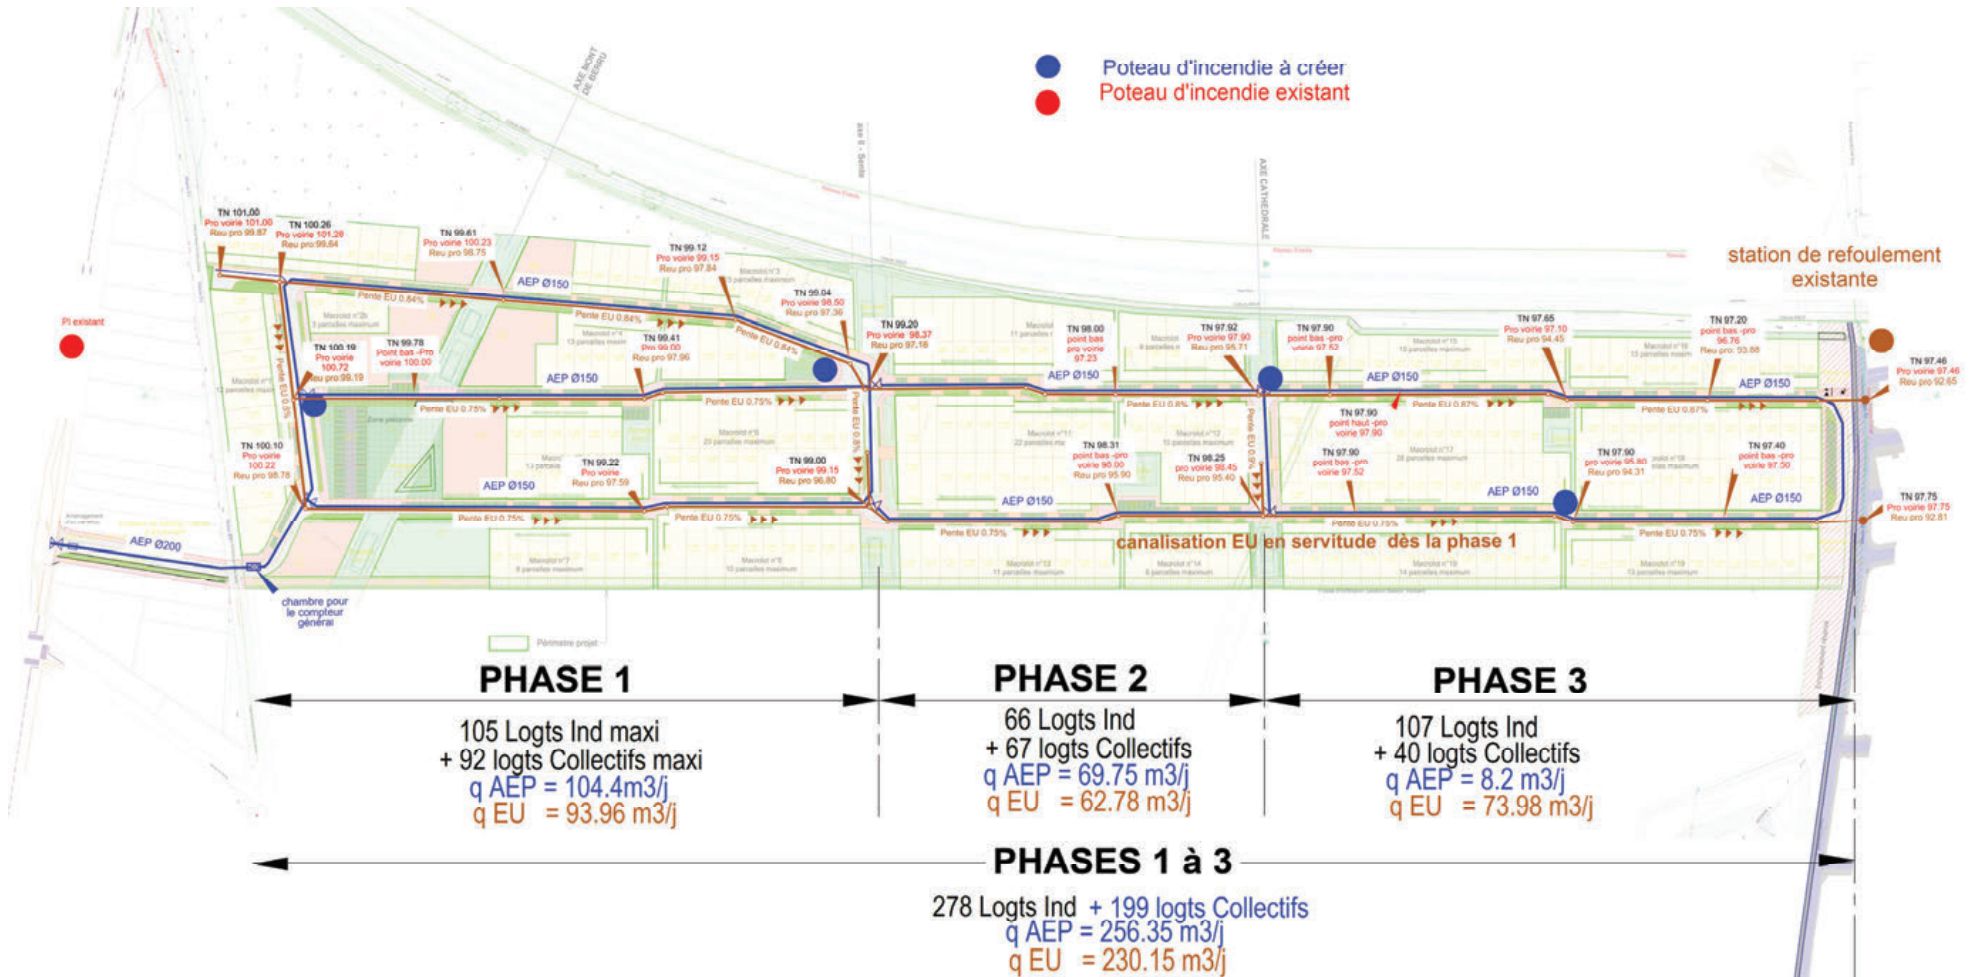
Plan des travaux prévus : eaux usées – eau potable (AWO)
